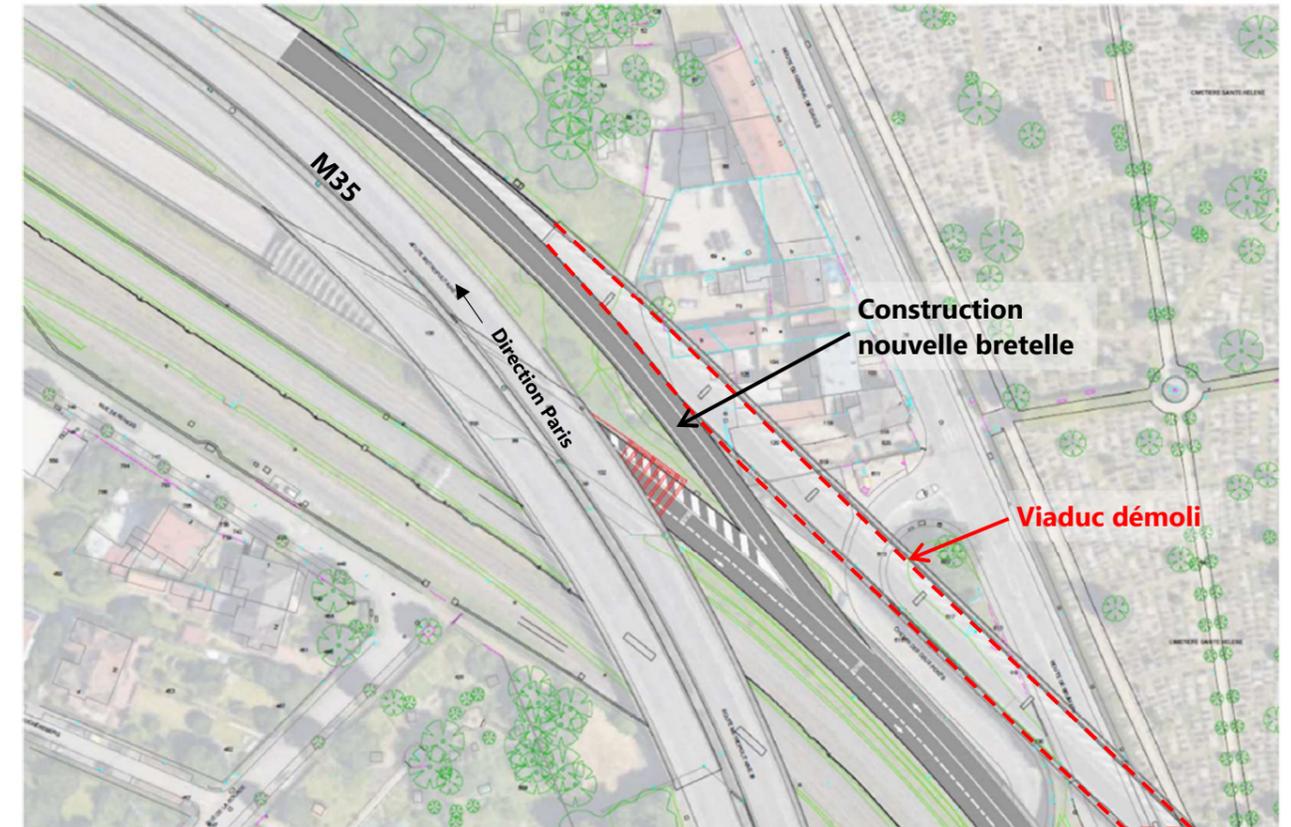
Plan de la nouvelle bretelle d'accès à la M35
